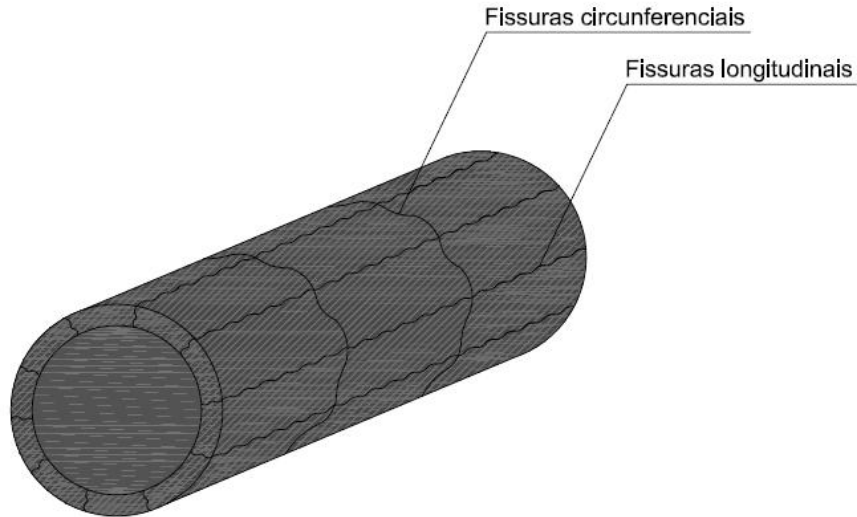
Tipos de fissuras presentes na galeria.
